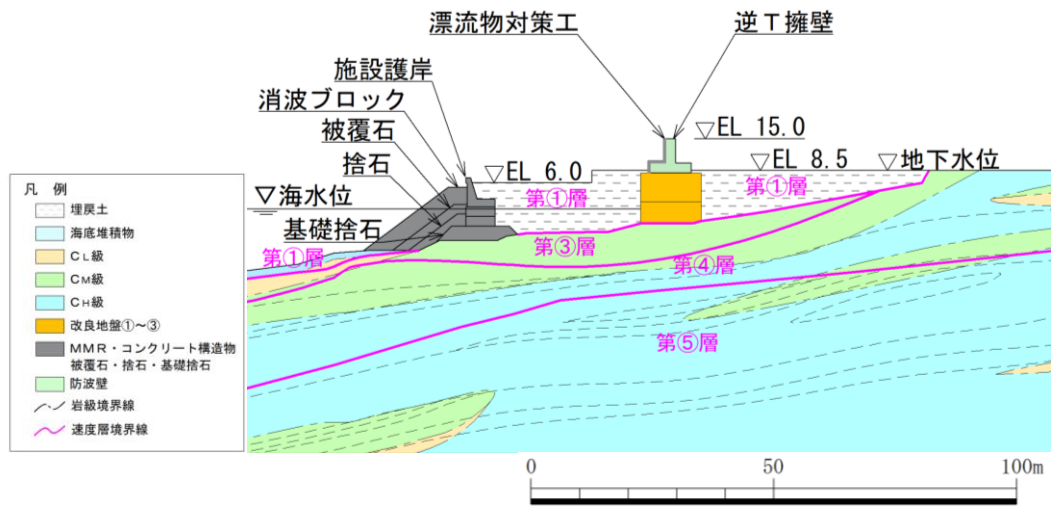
防波壁（逆 T 擁壁）の横断面図（①-①断面）
